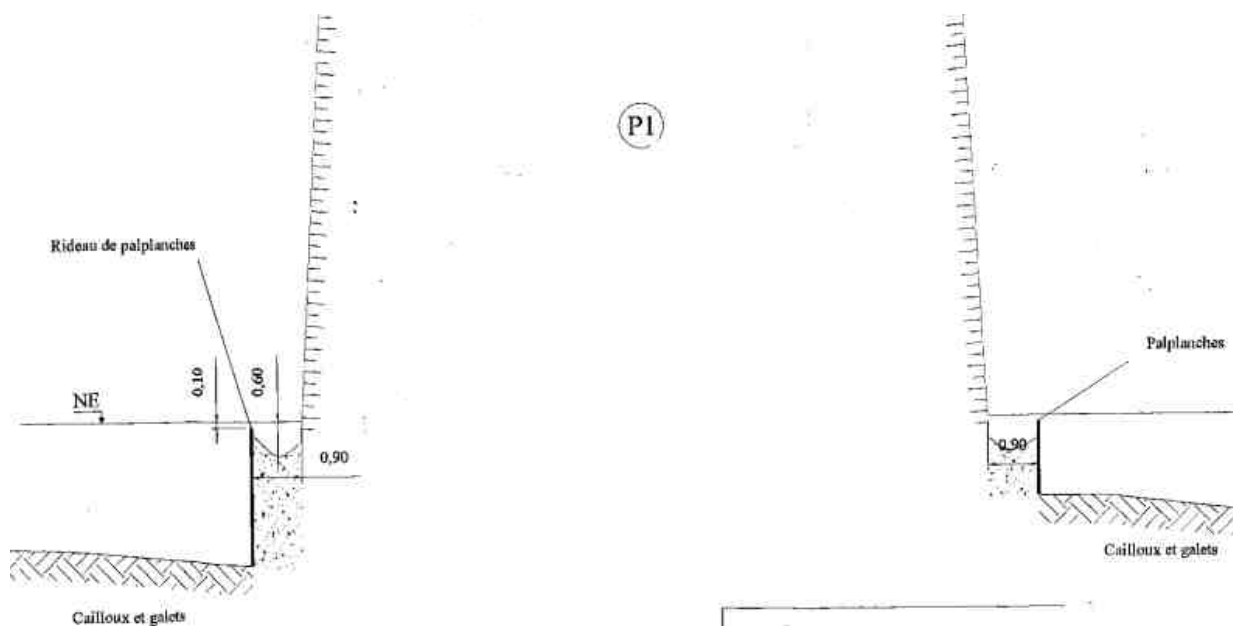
Coupe BB de la pile n°1 (CG, 2008)
